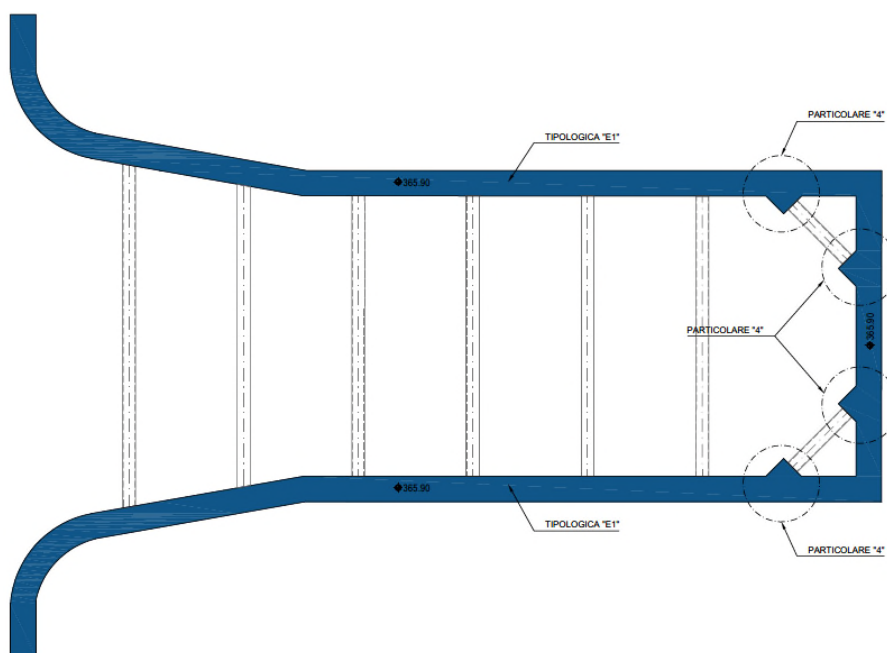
Pianta Trave di coronamento a q.ta +365.90m
